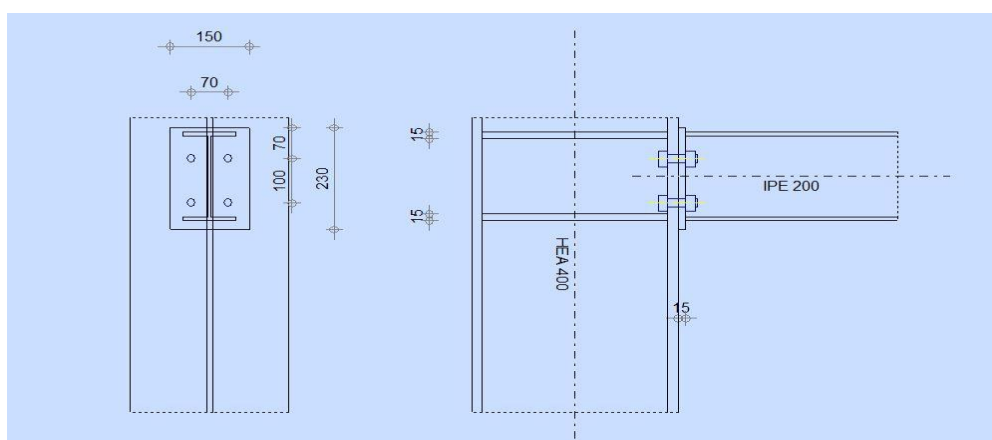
Détail sur l'assemblage poteau poutre secondaire.
